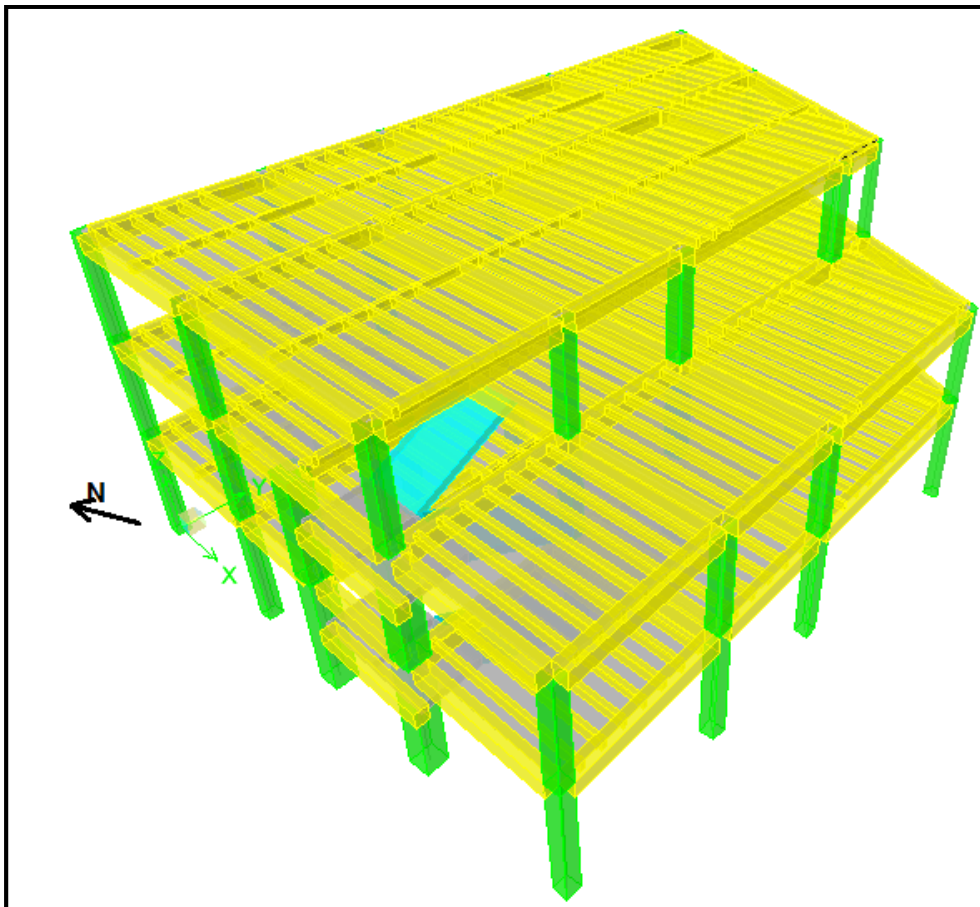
Vista 3D Edificio Módulo 3 (Fachada Norte - Lateral Oeste)
